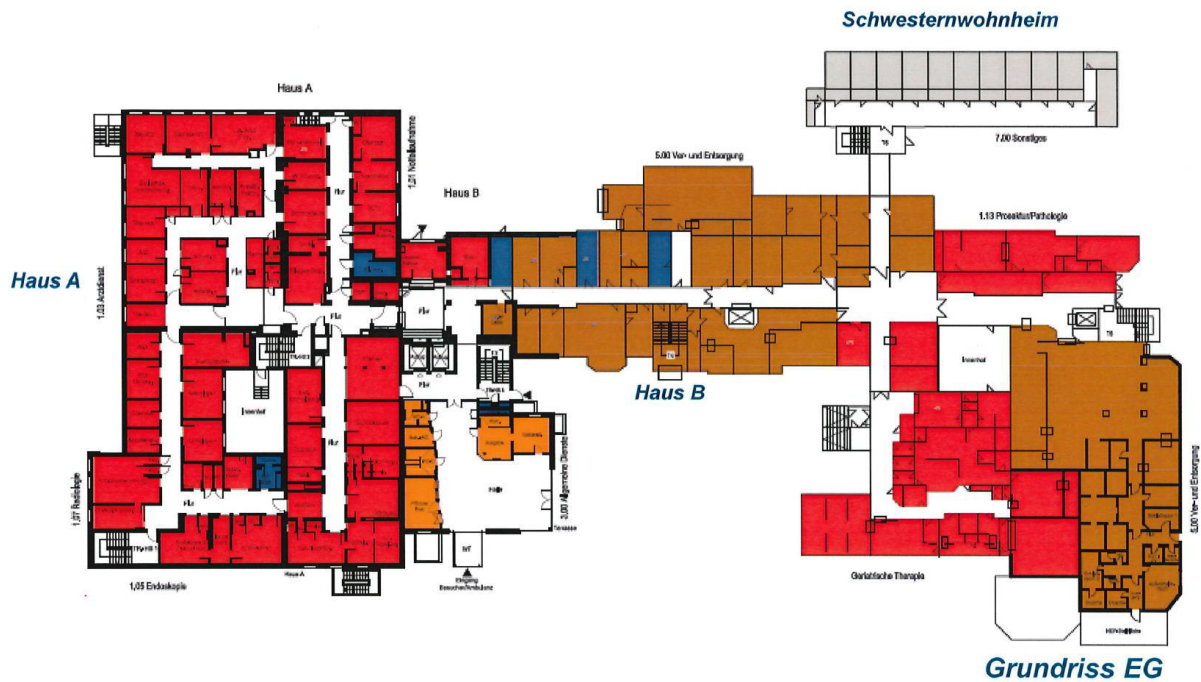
Grundriss Erdgeschoss Johanniter-Krankenhaus Gronau
